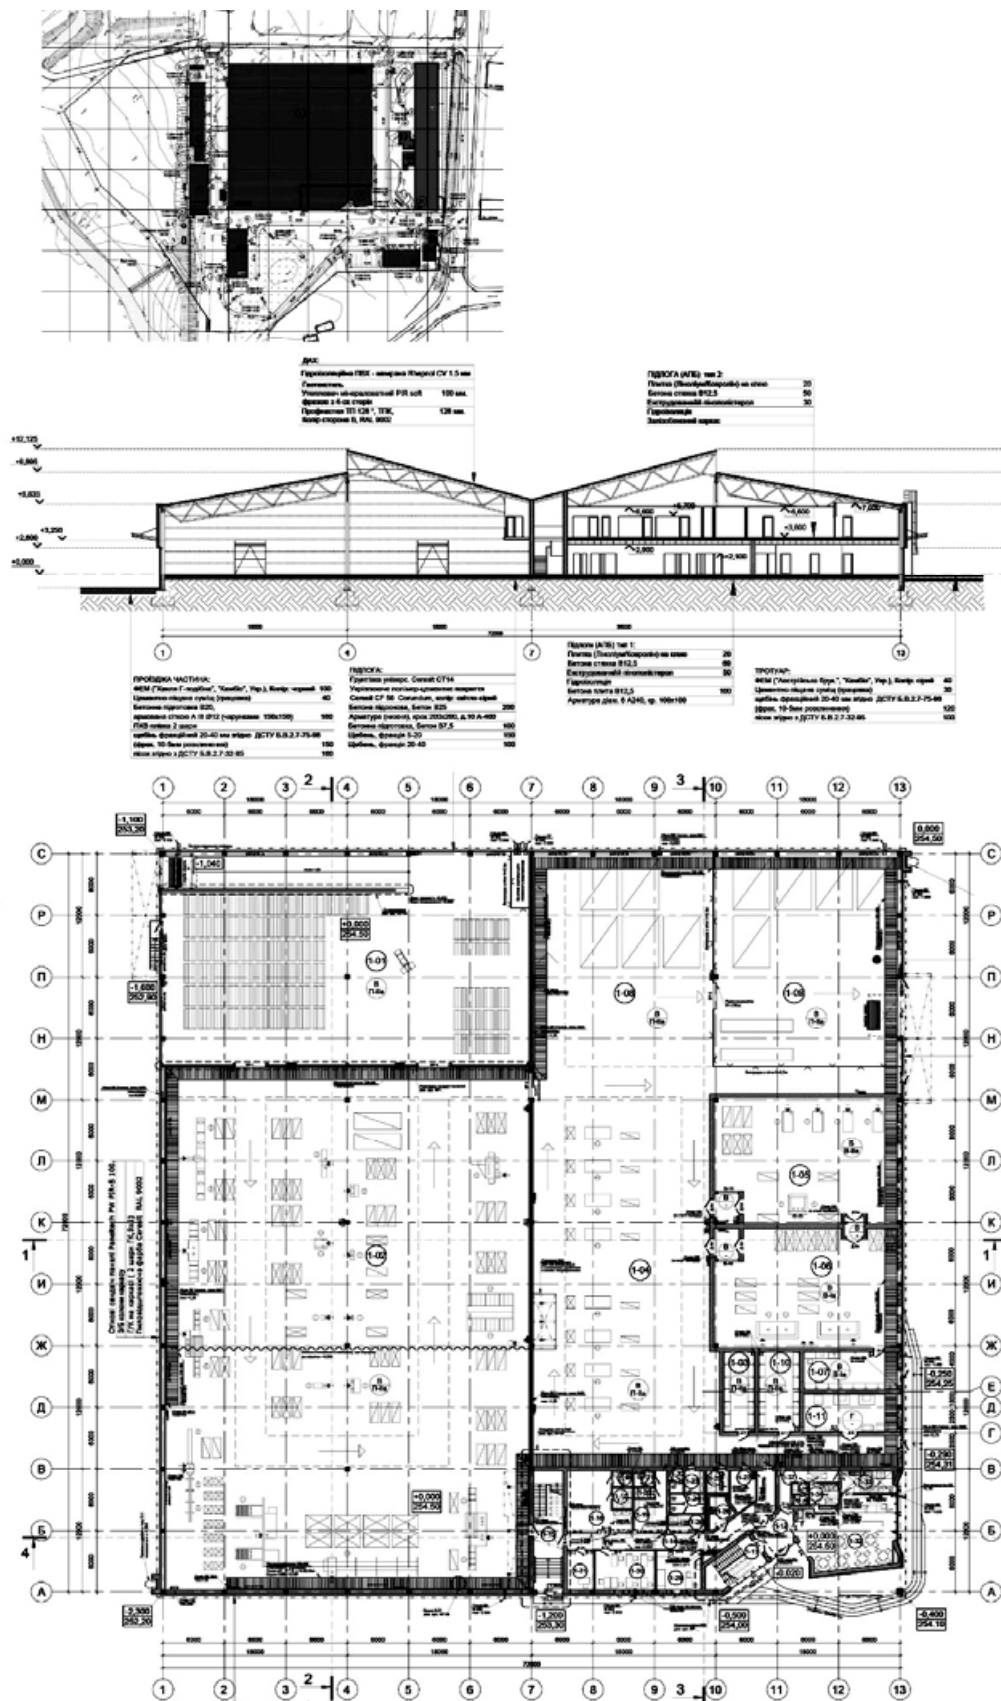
Креслення генплану, плану 1-го поверху та розрізу заводу “ВУДМАН”.
